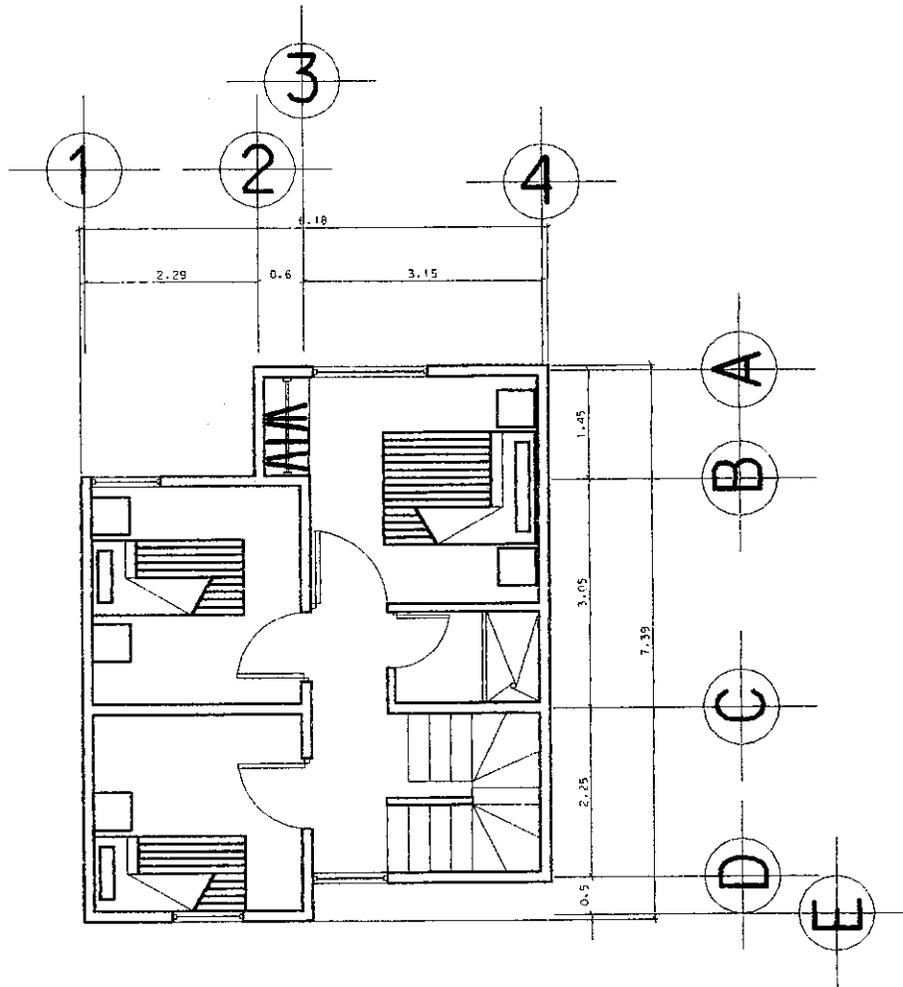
PLANTA AMUEBLADA DEL PRIMER NIVEL
